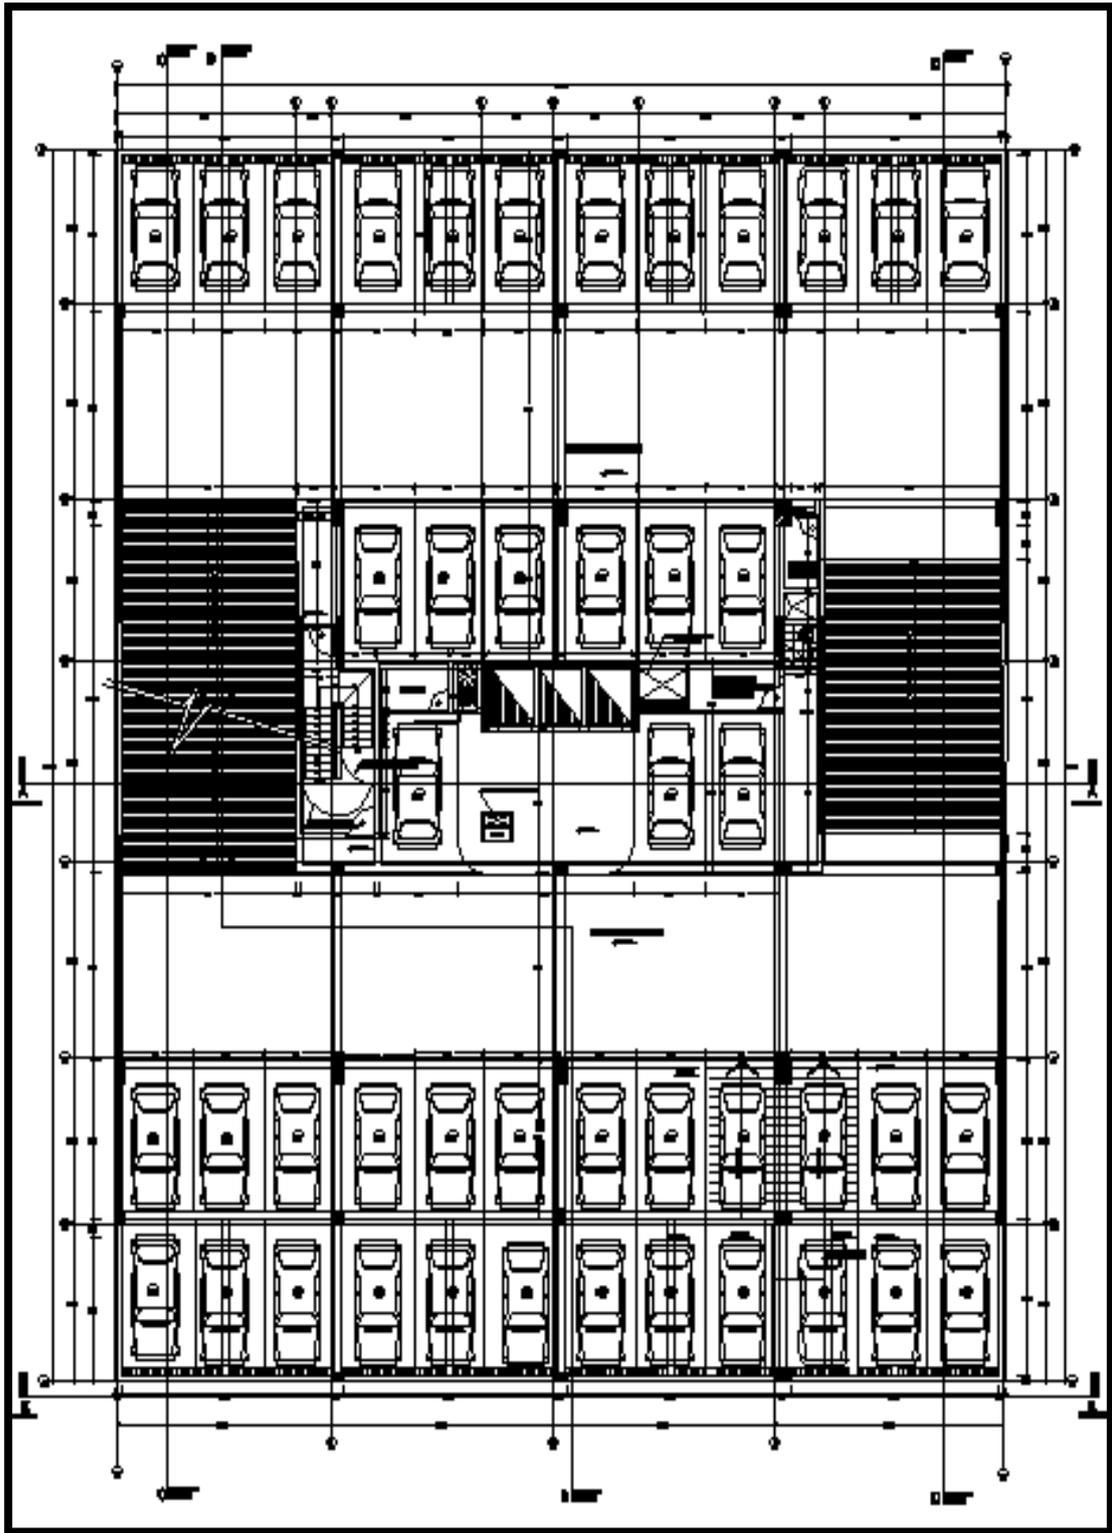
Plano de Arquitectura estacionamientos – primer sótano
